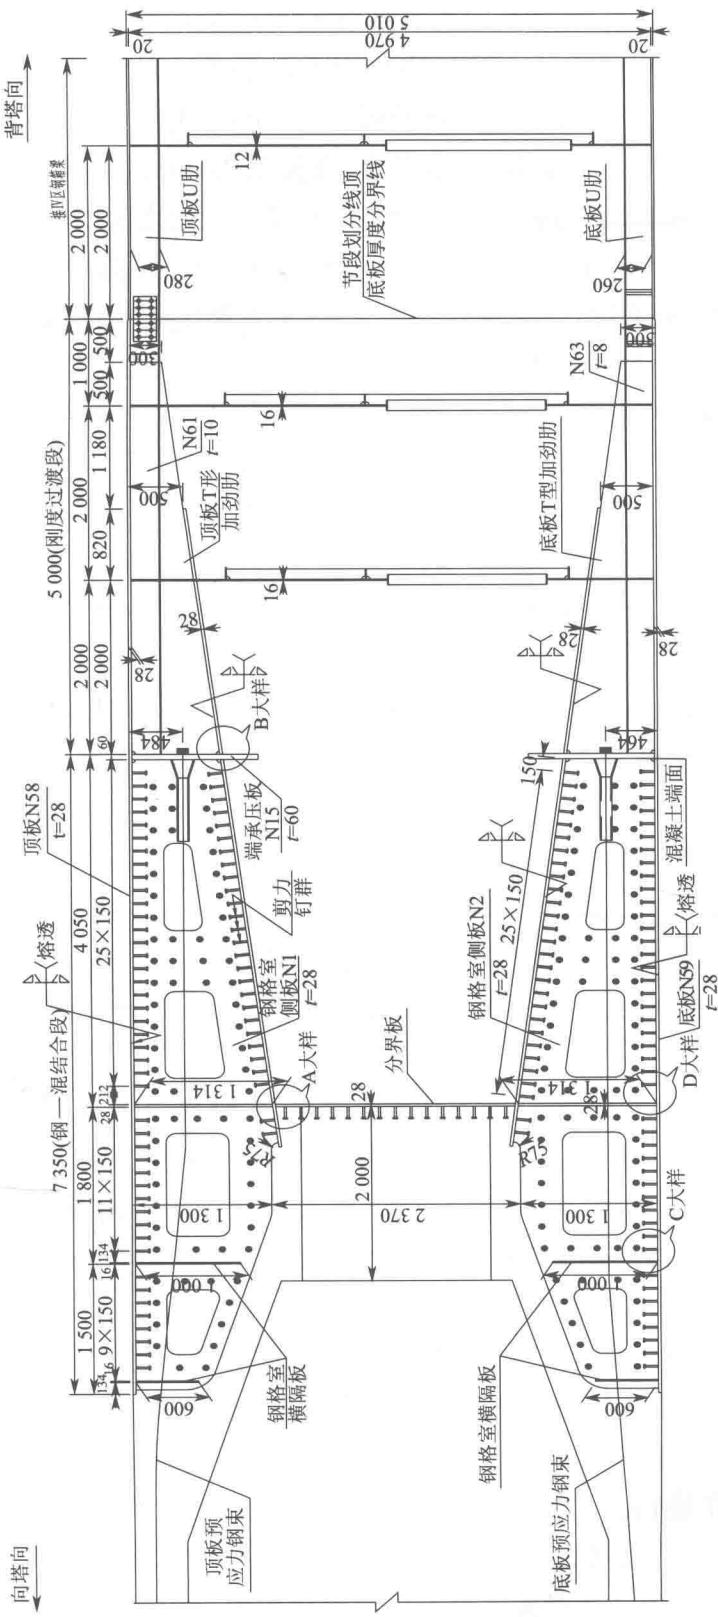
钢—混结合段纵向连接剖面图(单位:mm)
